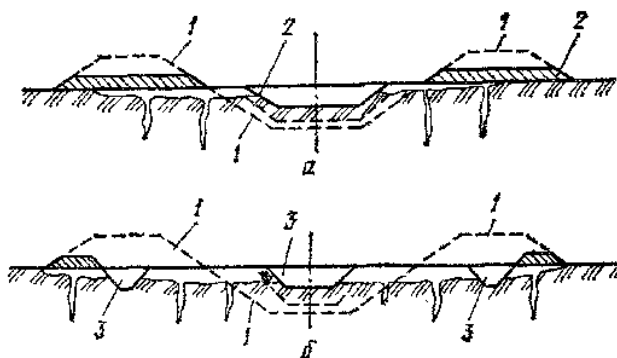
Последовательность строительства каналов в просадочных грунтах:
